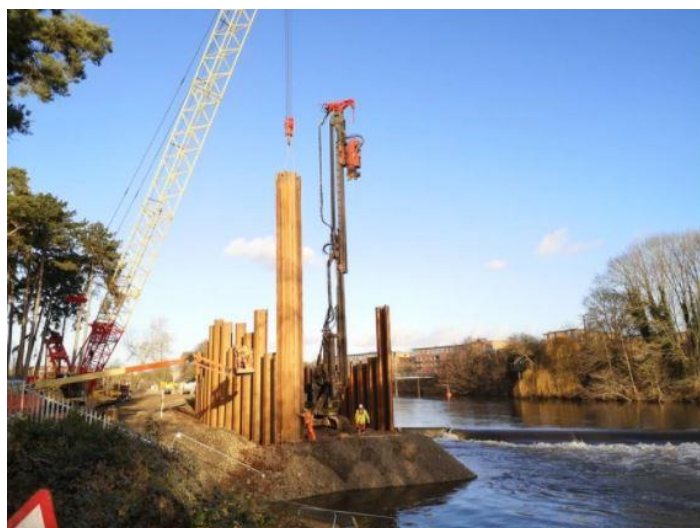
Construction de la passe verticale profonde de Diglis (Source : Crundwell)
